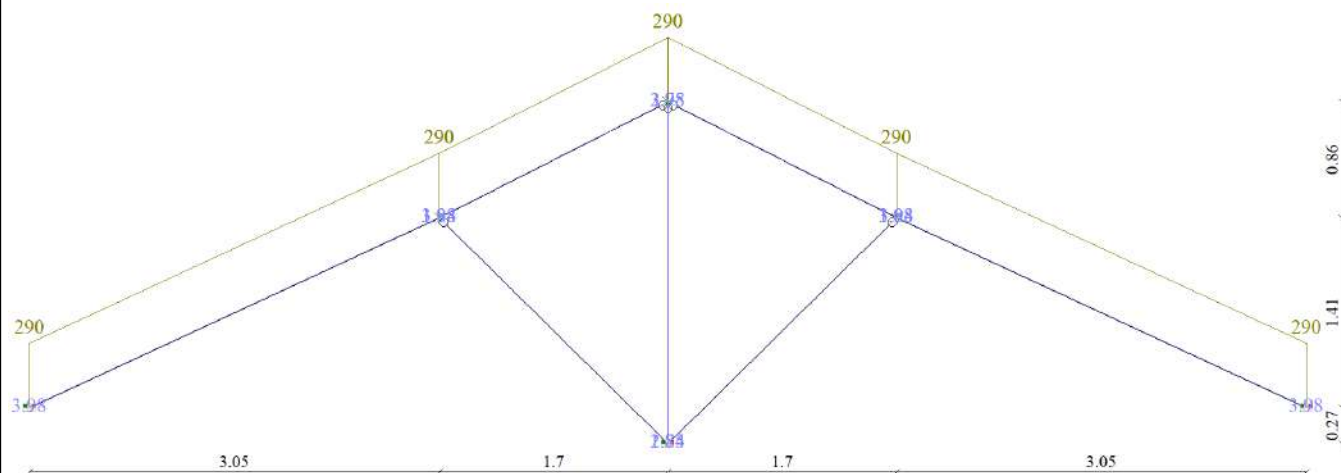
Расчетная схема стропильной конструкции с приложенной нагрузкой, (кг/м.п)
